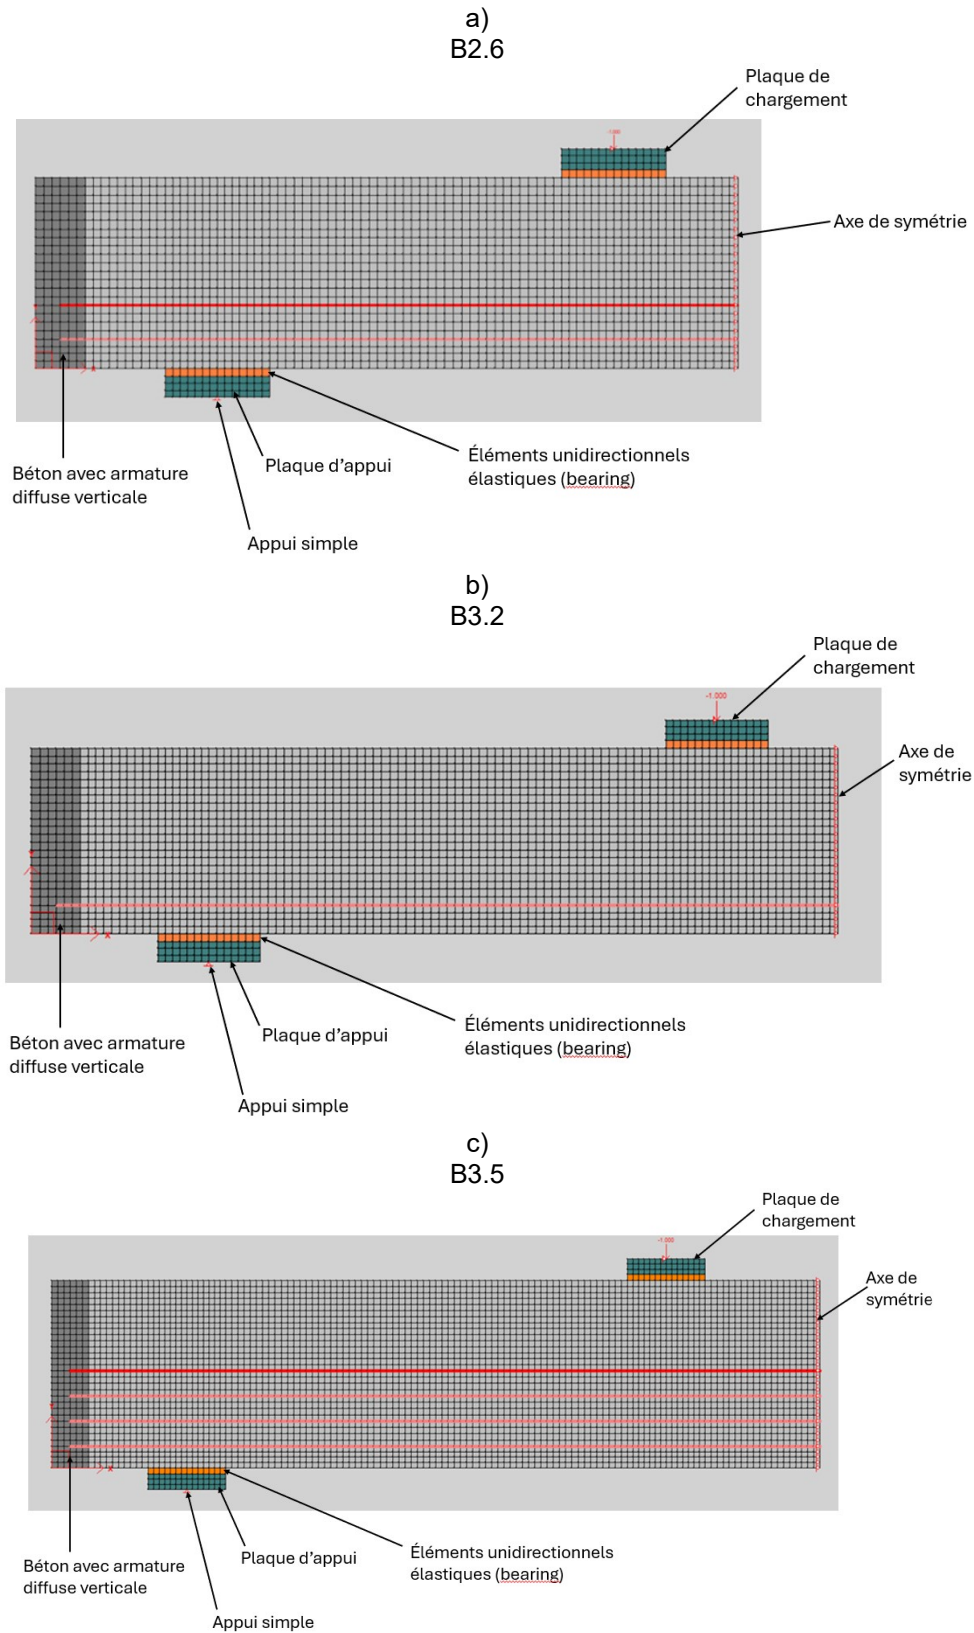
Maillage des poutres a) B2.6, b) B3.2 et c) B3.6
